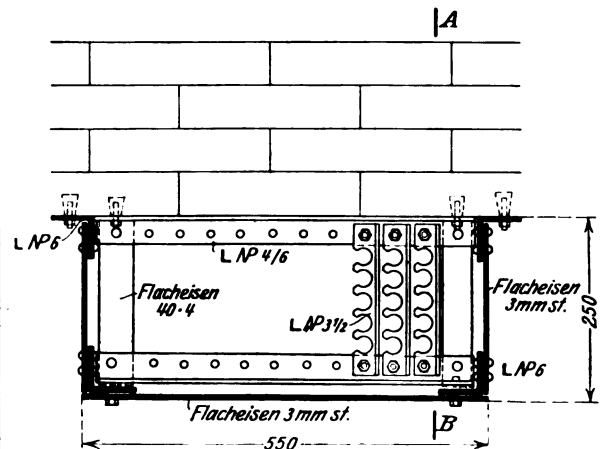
Kabelbefestigung mit Schellen auf eingeschnittenem Winkelisen.
